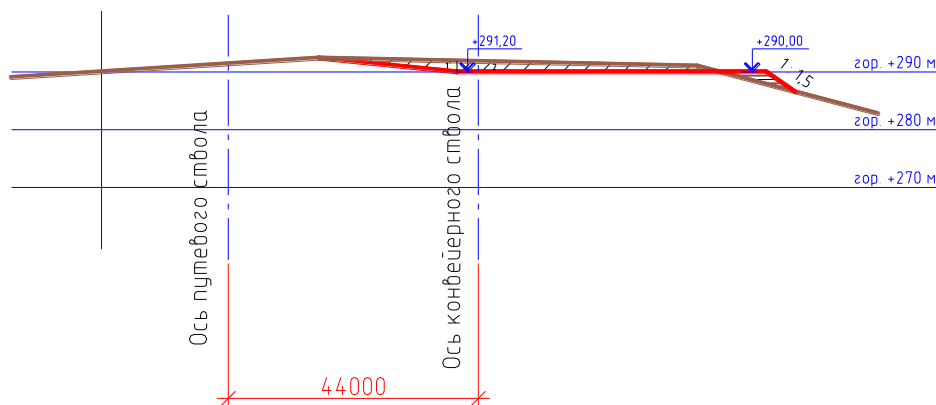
Поперечный разрез 1-1 площадки 1
